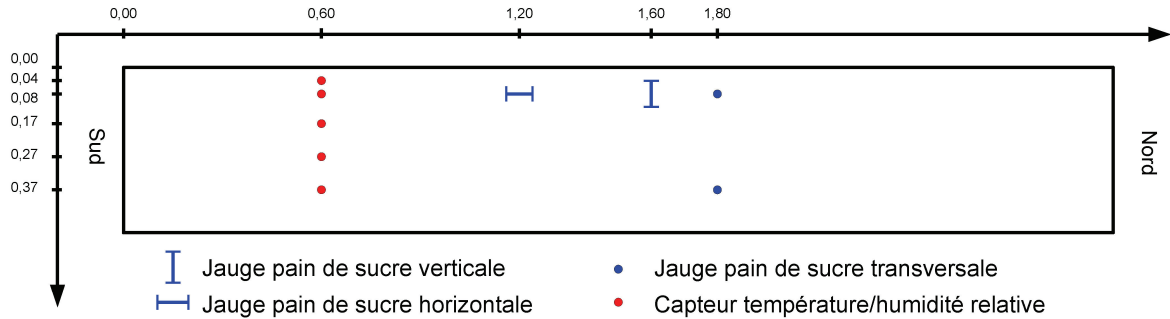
3 : plan d'instrumentation interne de la poutre P1
